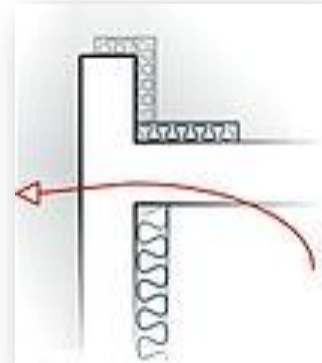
Jonction plancher haut/mur extérieur
